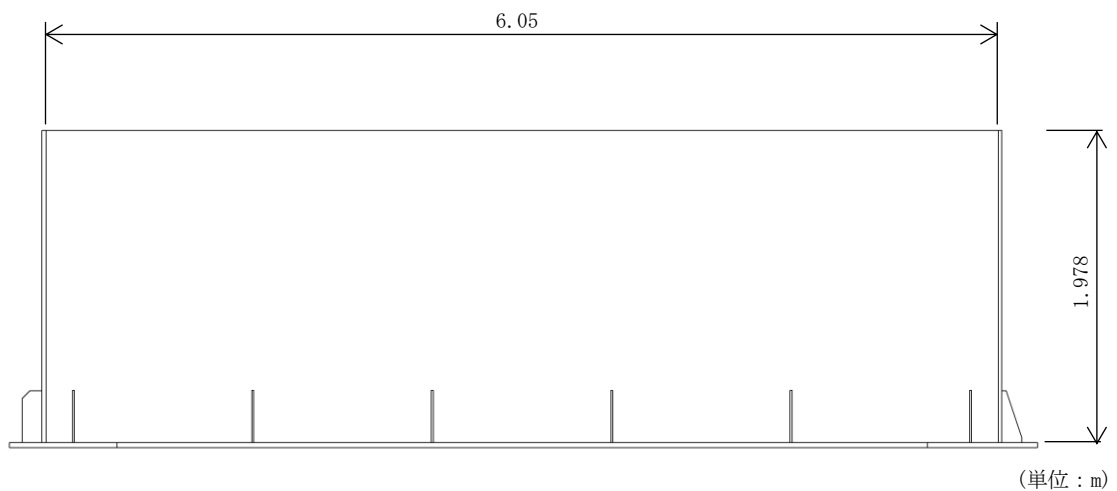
取水槽海水ポンプエリア竜巻防護対策設備の平面図
